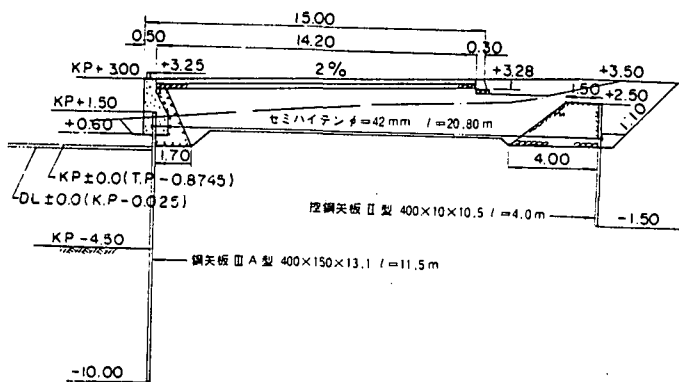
石巻港潮見埠頭-4.5m岸壁断面図
